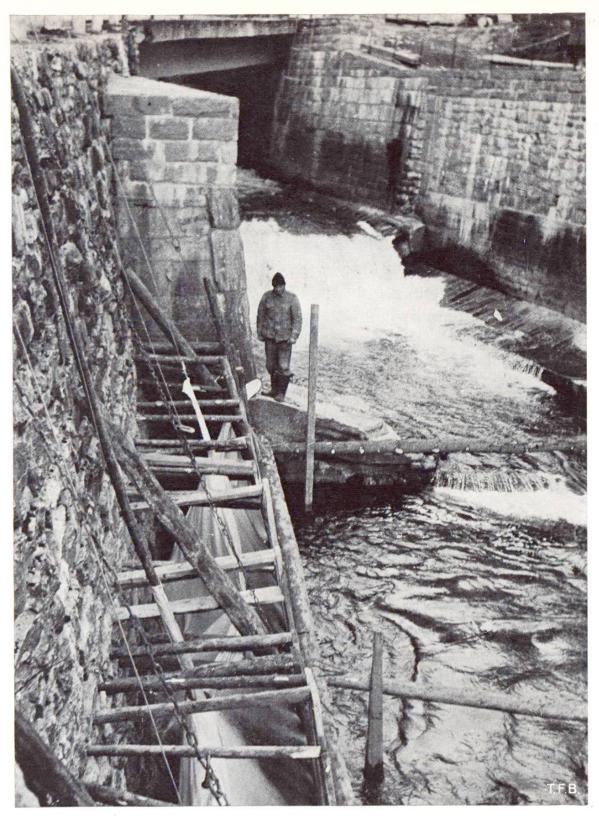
Vue du container Colcrete protégé par un coffrage auxiliaire. On remarque au premier plan le tube pour le remplissage de l'enveloppe au moyen de mortier Colcrete.
